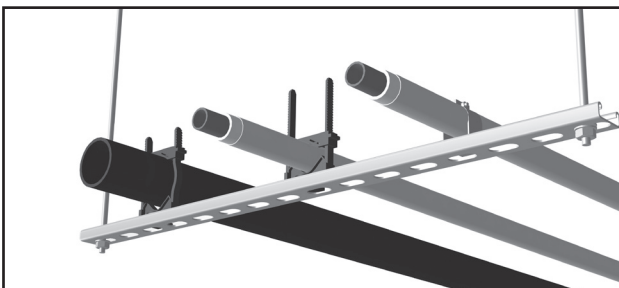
Soporte típico de tubería PEX para suspensión trapezoidal
